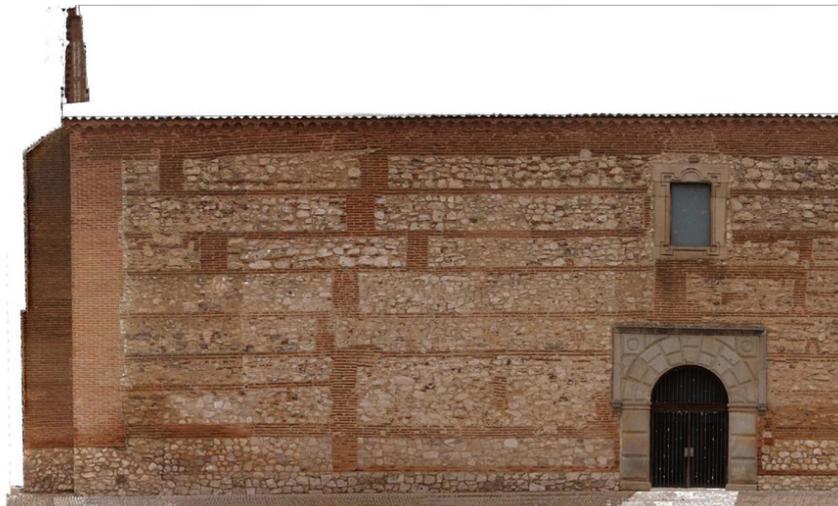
Iglesia de Muriel de Zapardiel (VA). Detalle de fachada norte, se presenta la zona reconstruida cuyo sistema constructivo es distinto al resto de la nave.
